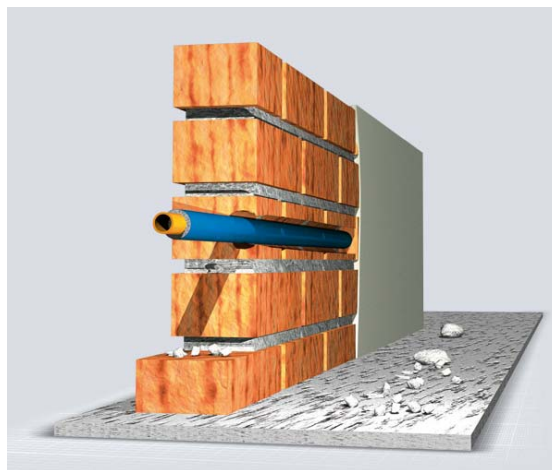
Sección de una pared que muestra una tubería aislada con una espuma flexible encastada.
